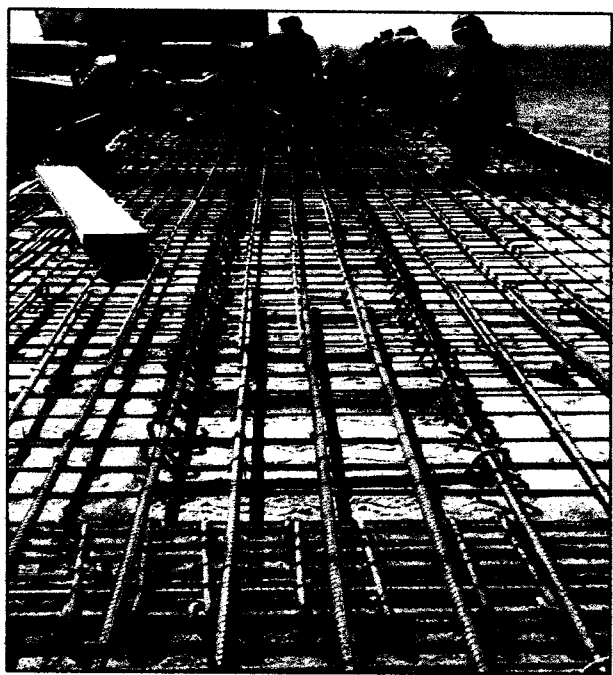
Habilitación de acero de refuerzo en losa e: 20 cm.
